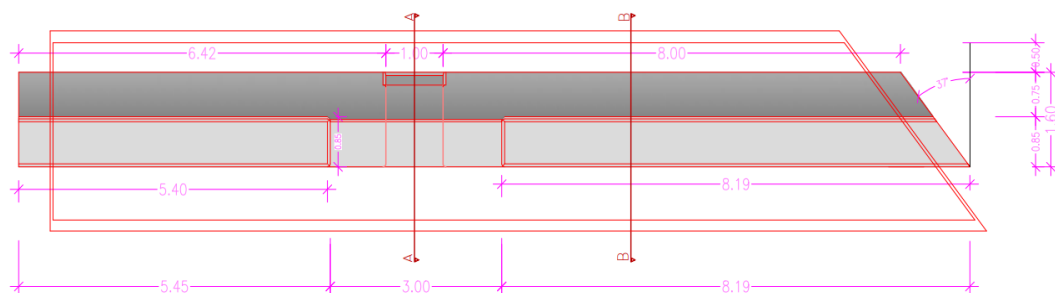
Planta. Estrutura de retenção da bacia a Jusante. Fonte: Projegui.
